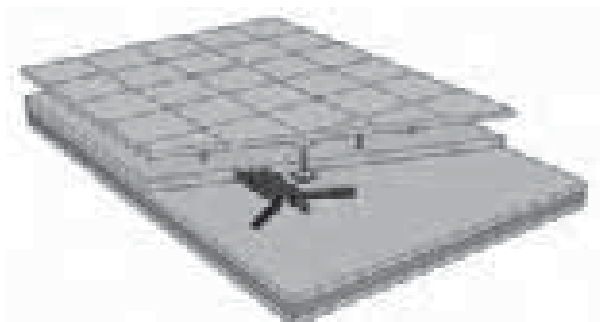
Pavimento galleggiante modulare montato su solaio XLam
